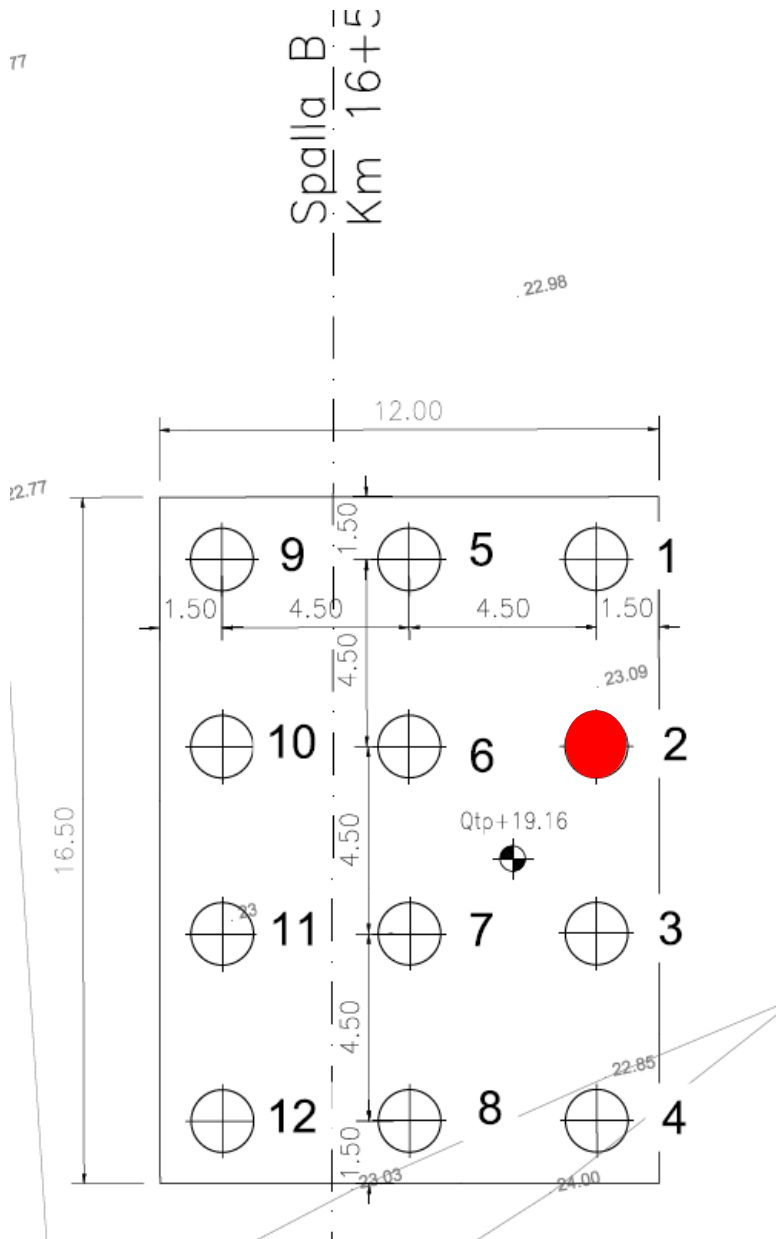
palificata a 12 pali spalla B – PE (stralcio planimetria di tracciamento pali di PE)
